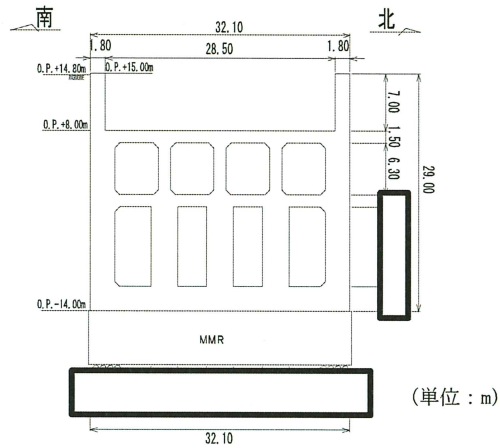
第 3 号機海水ポンプ室断面図 (A-A 断面, 南北 (スクリーンエリア))
